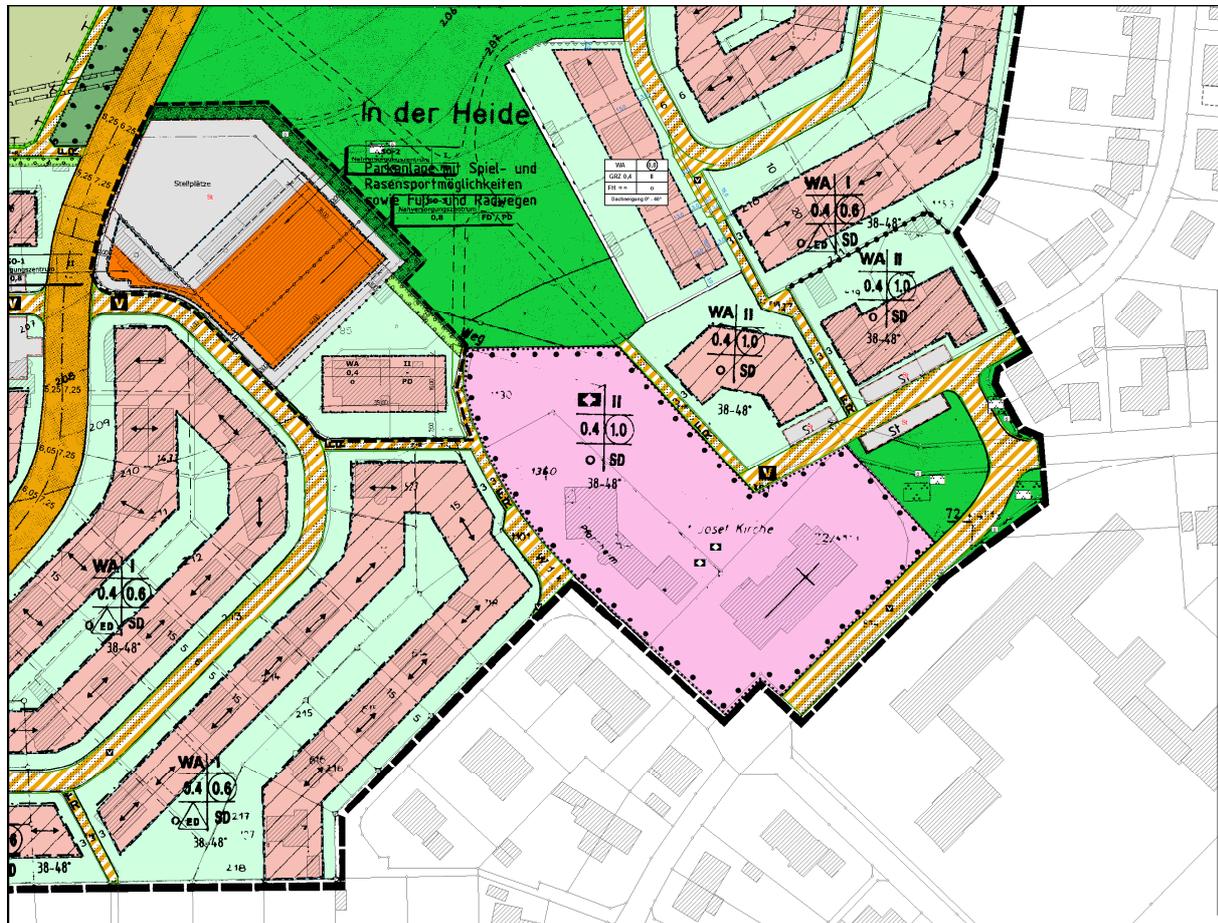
Auszug aus den Bebauungsplänen NH 116 mit 1., 2. und 3. Änderung
